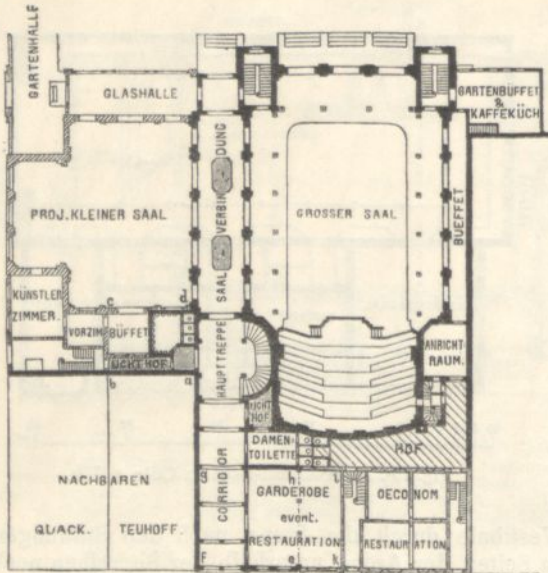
Stadthalle in Crefeld. Erdgeschoss.
